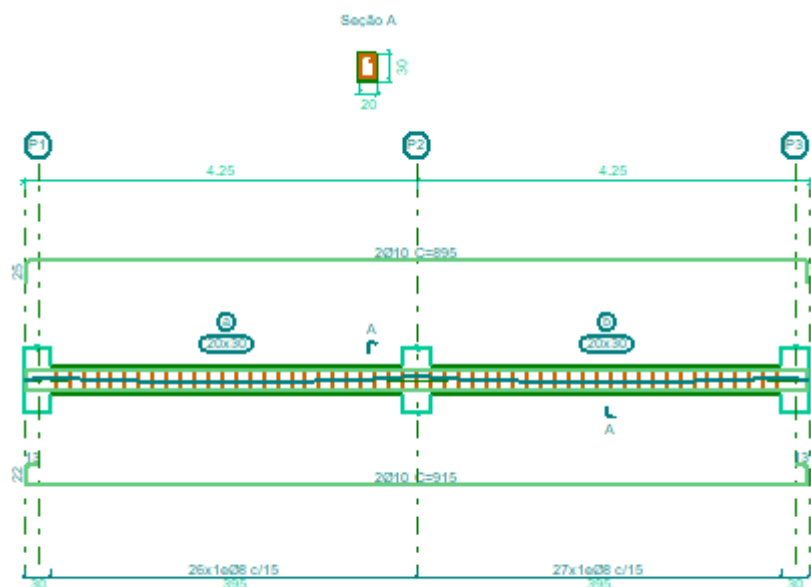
Edição do dimensionamento de vigas (Antes da edição da viga)
